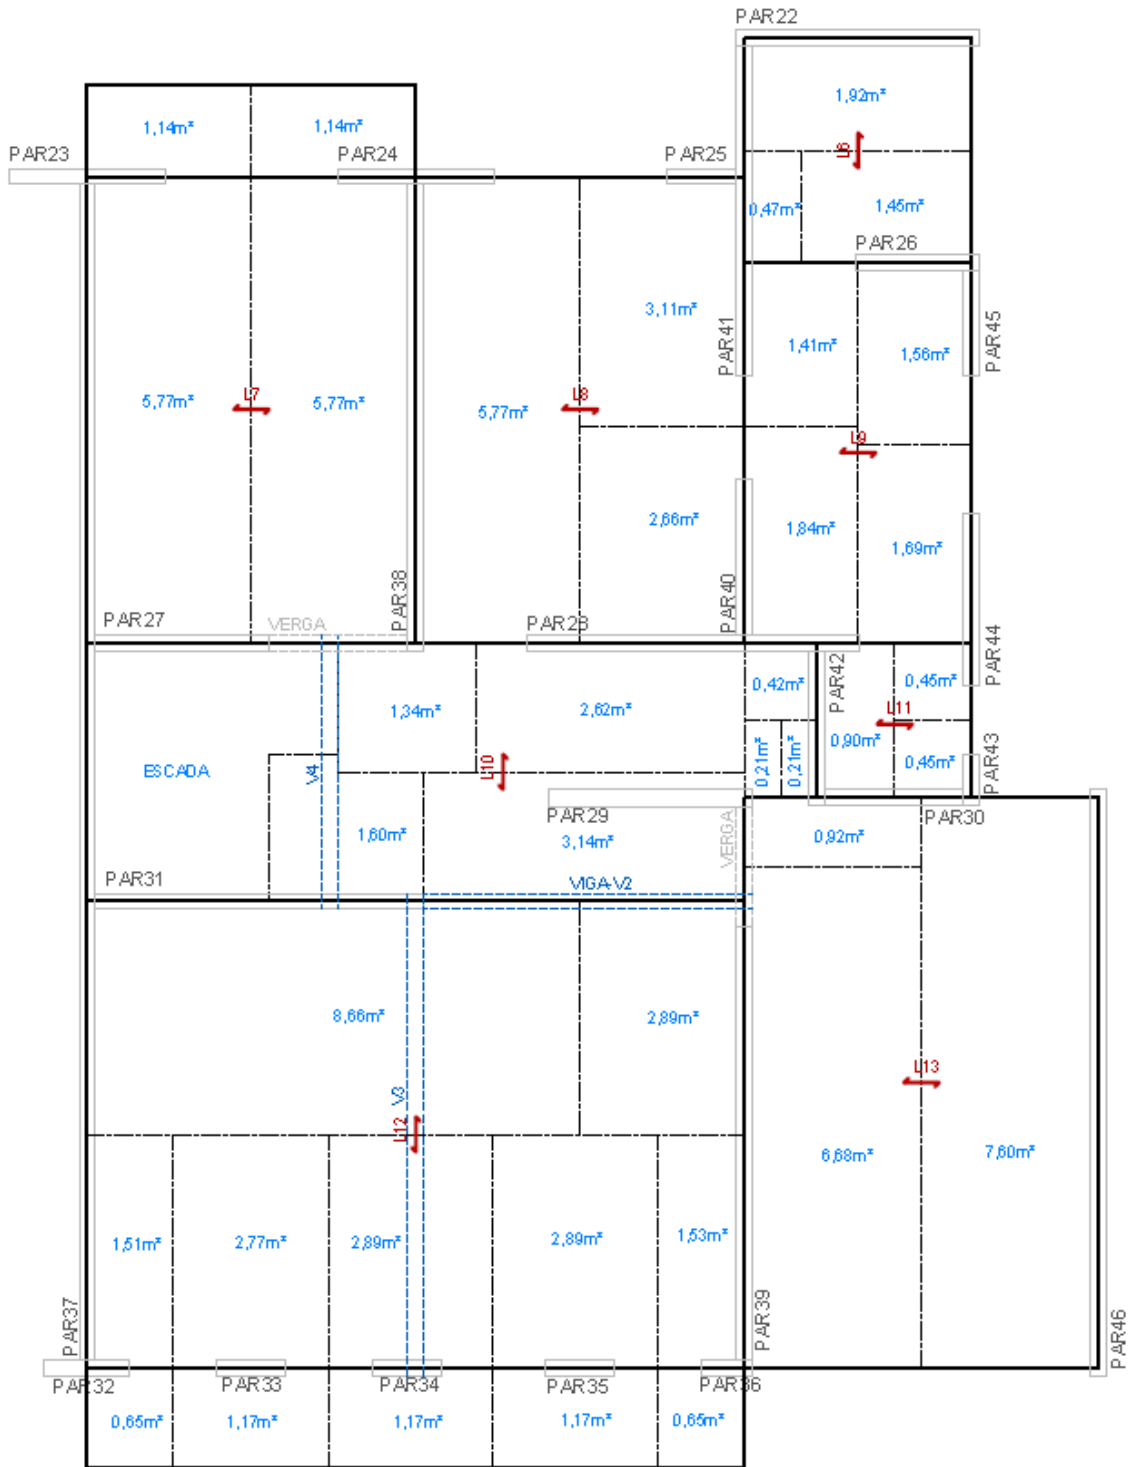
6 Especificação da região de apoio das lajes, Pavimento Térreo.
